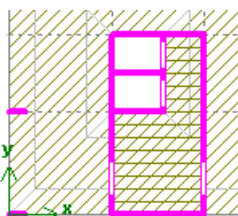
Плита перекрытия с нагрузкой (фрагмент)
